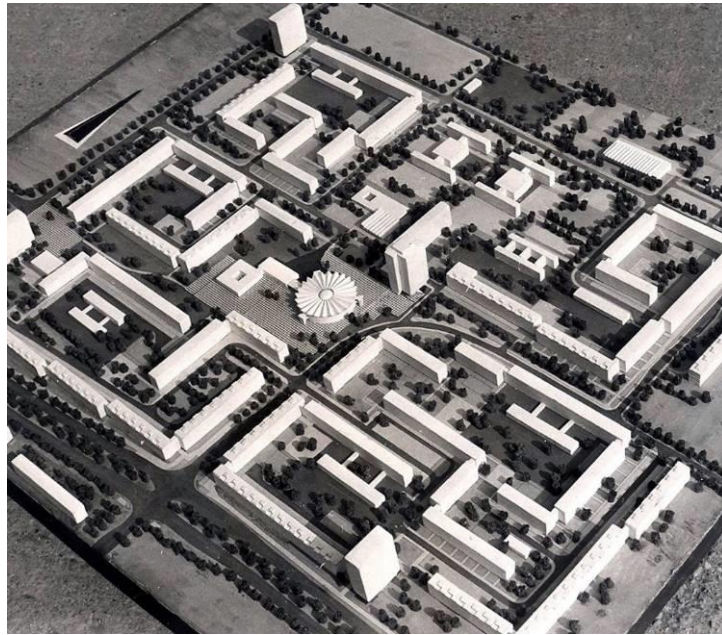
Макет планування житлового комплексу III у Halle-Neustadt [2]
